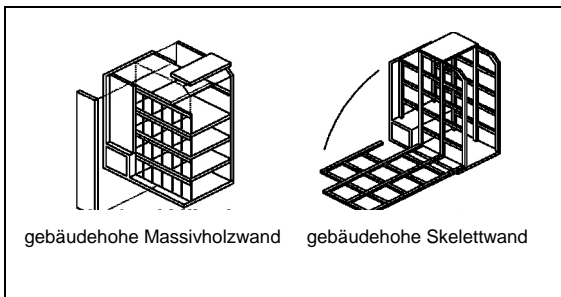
Montage von gebäudehohen Wandelementen durch „hochklappen“ und Einheben
